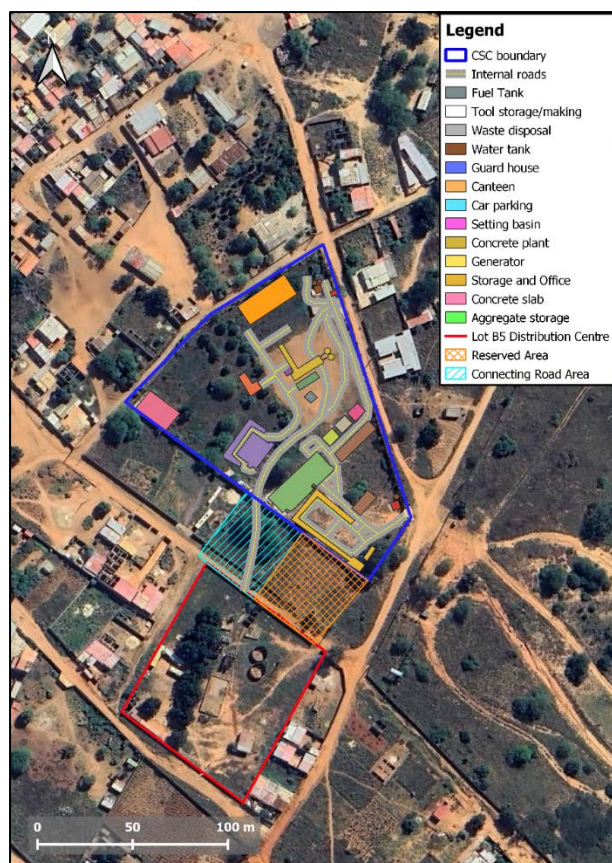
Área do Estaleiro de Apoio à Construção do B5 e área reservada (Fonte: Dar, 2025)
